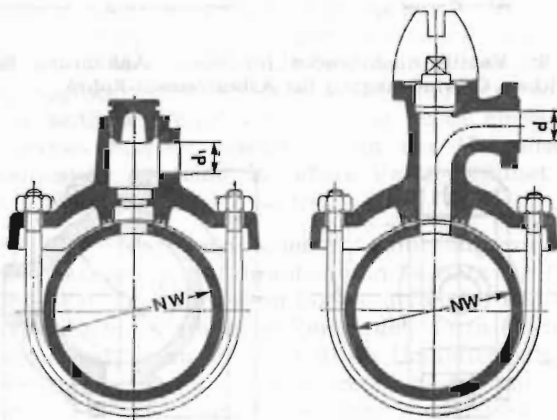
Anbohrschelle für obere Anbohrung mit seitlichem Gewindeabgang für Einbauventil
